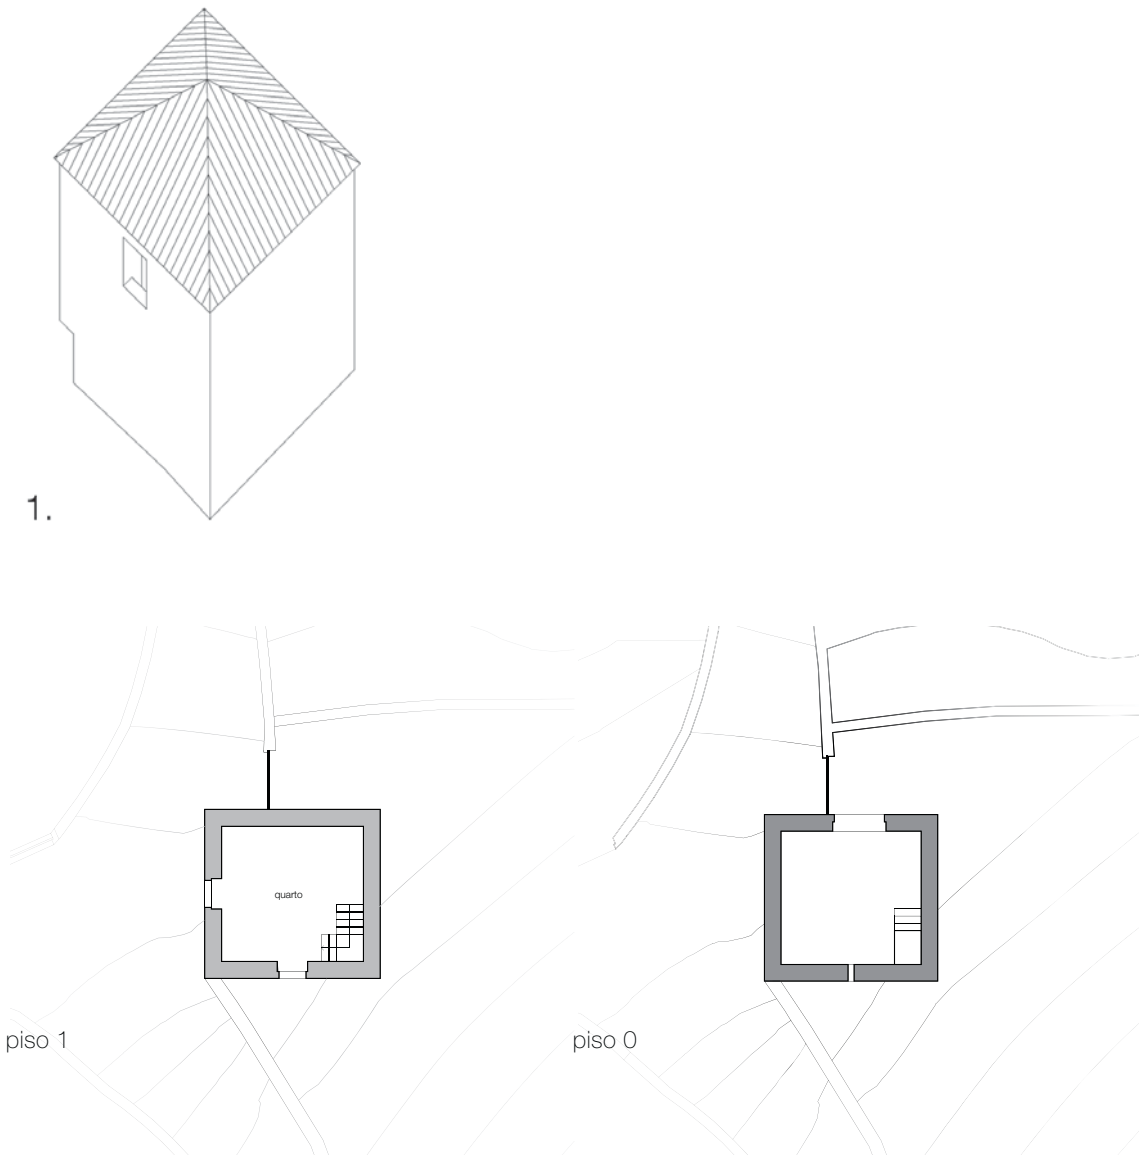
Axonometria e plantas pisos 0 e 1, casa 2 - Existente
